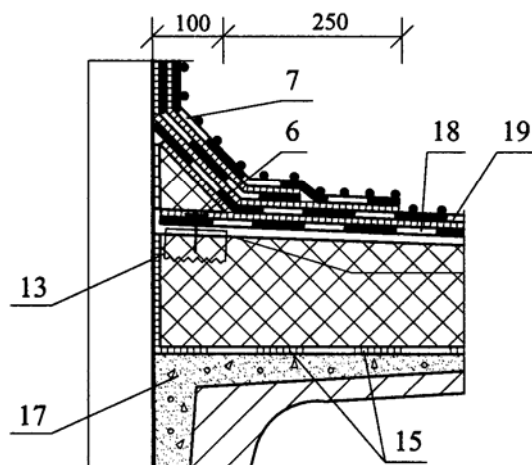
Примыкание кровли из полимерной плёнки с механическим креплением
